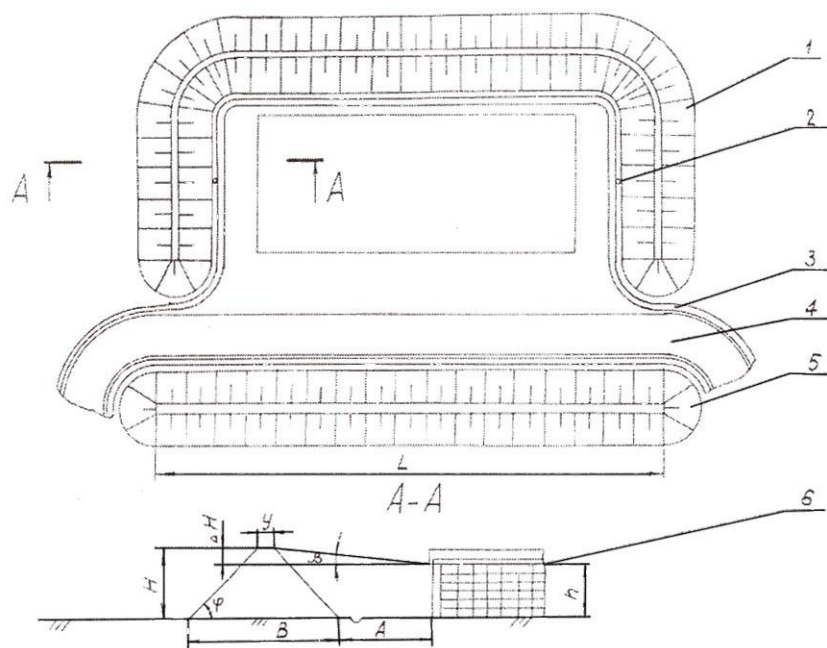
Схема обвалования хранилища с боеприпасами
